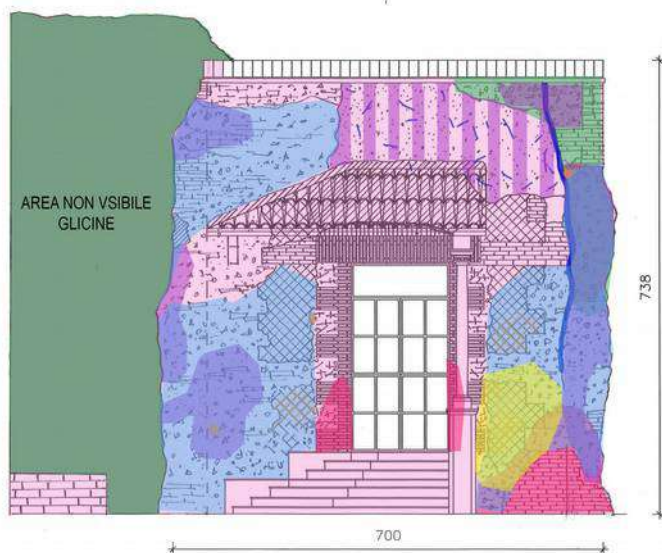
Prospetto Est - Particolare delle fessurazioni che attraversano la muratura.
